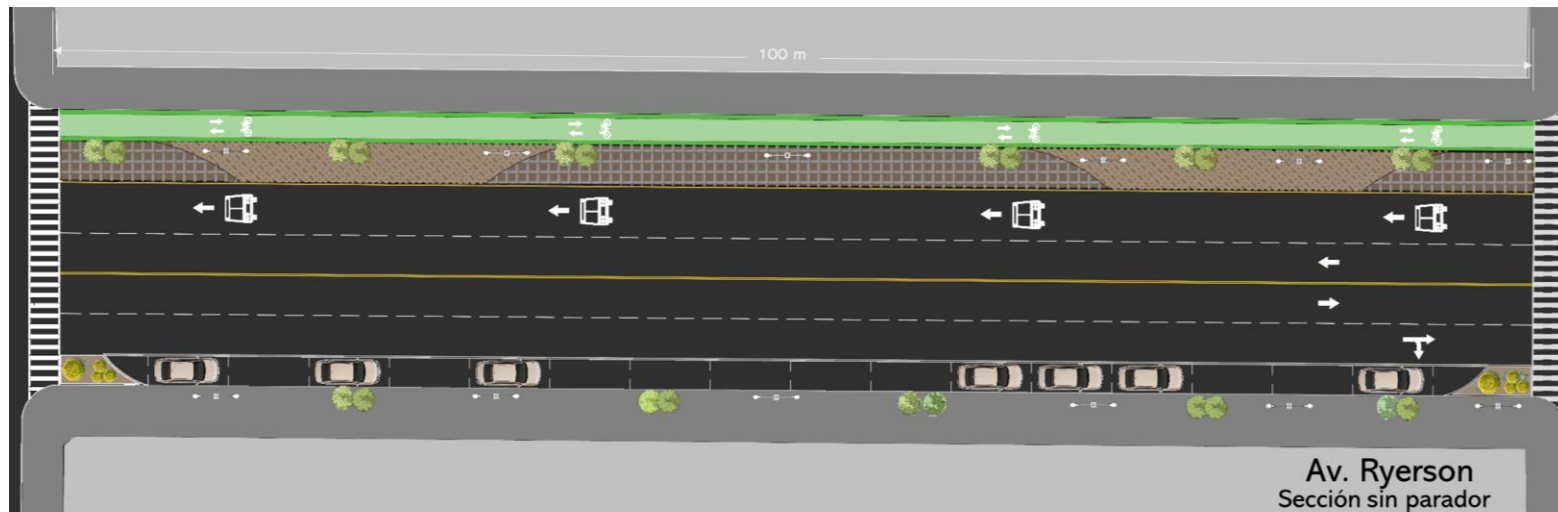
Detalle distribución de propuesta para avenida Ryerson.
